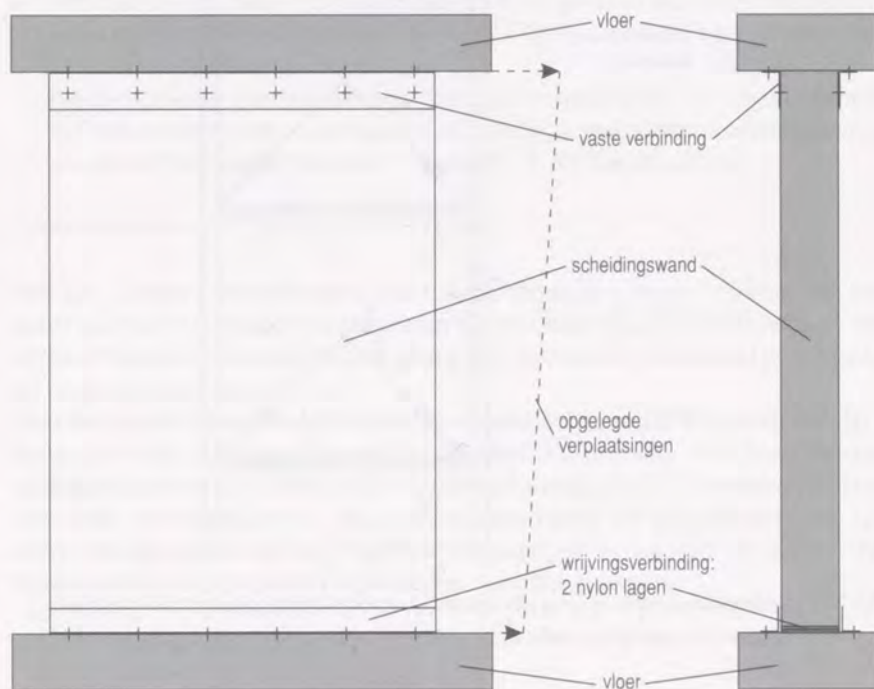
Aanzicht en doorsnede van een scheidingswand met wrijvingsverbinding
